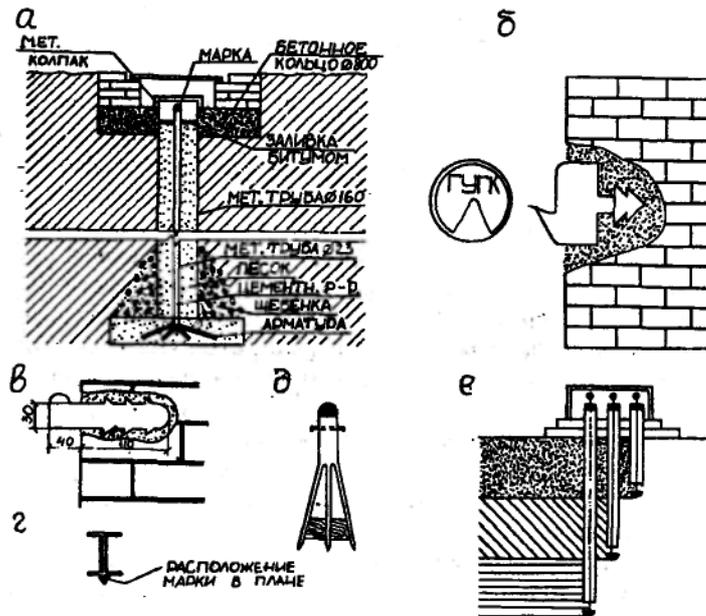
Геодезические знаки для наблюдения за осадками: а – глубинный репер; б – стенной репер; в – осадочная марка, закрепляемая в кирпичные или бетонные стены; г – осадочная марка, закрепляемая сваркой к металлической колонне; д – глубинная марка, закрепляемая в земляные сооружения; е – куст марок для определения величины послойного сжатия грунта
